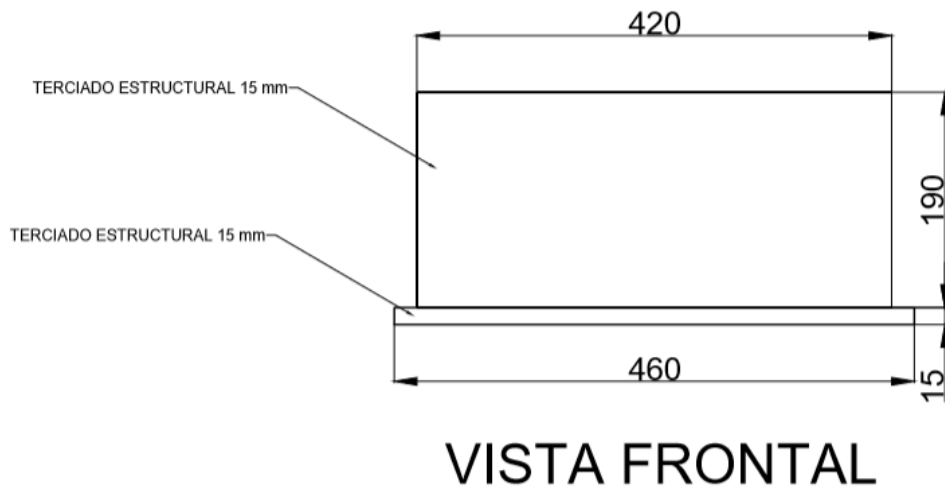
Diseño moldaje del bloque con eco-ladrillo, vista frontal.
